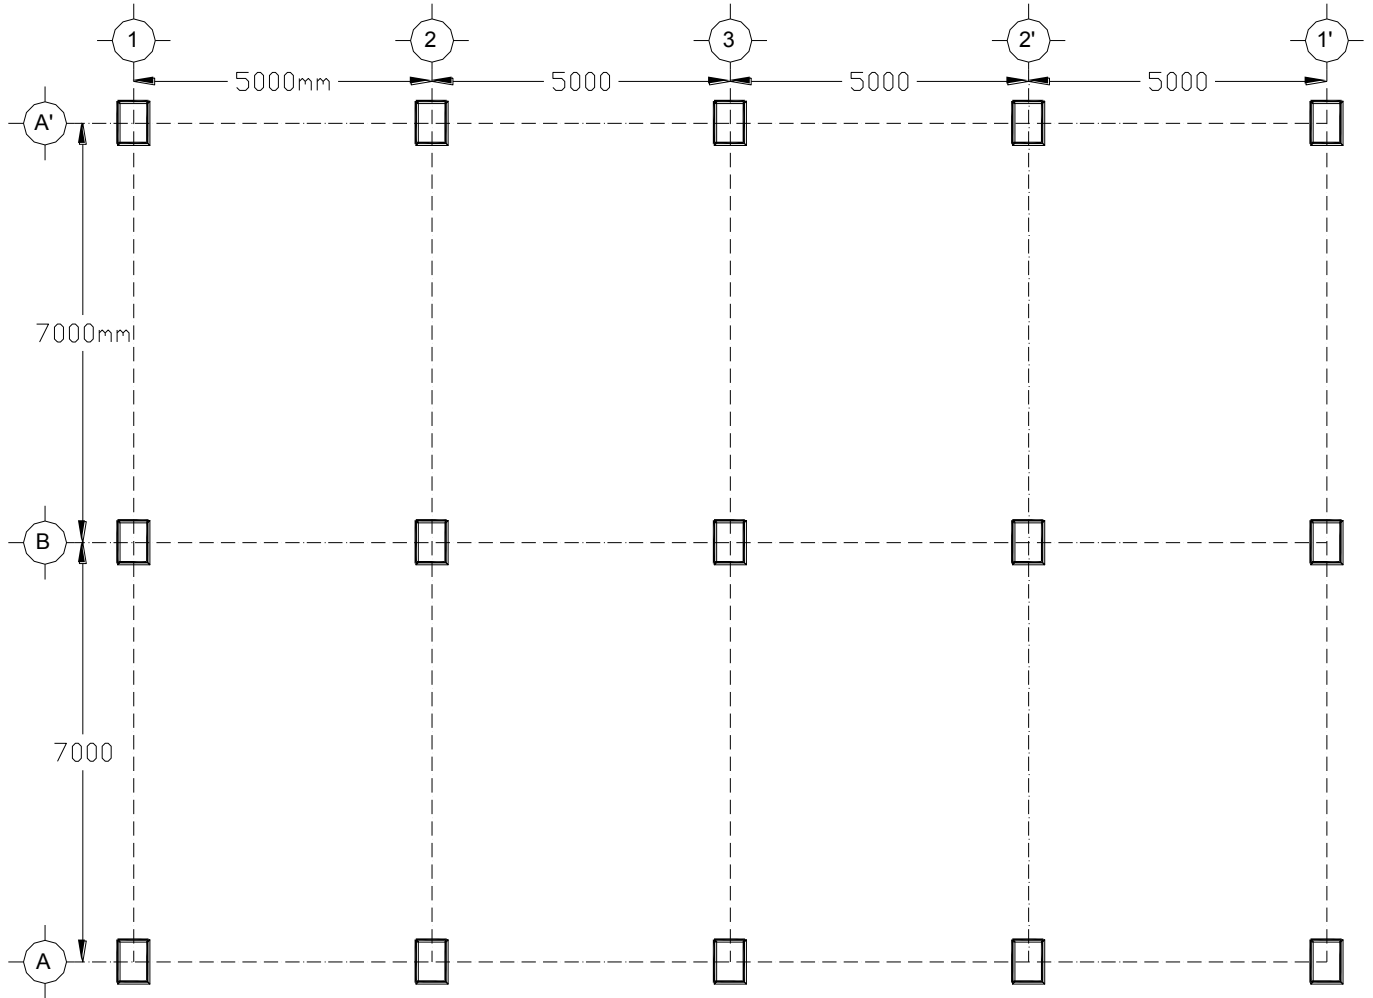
Losa en planta del nivel 2, del ejemplo 6.1
